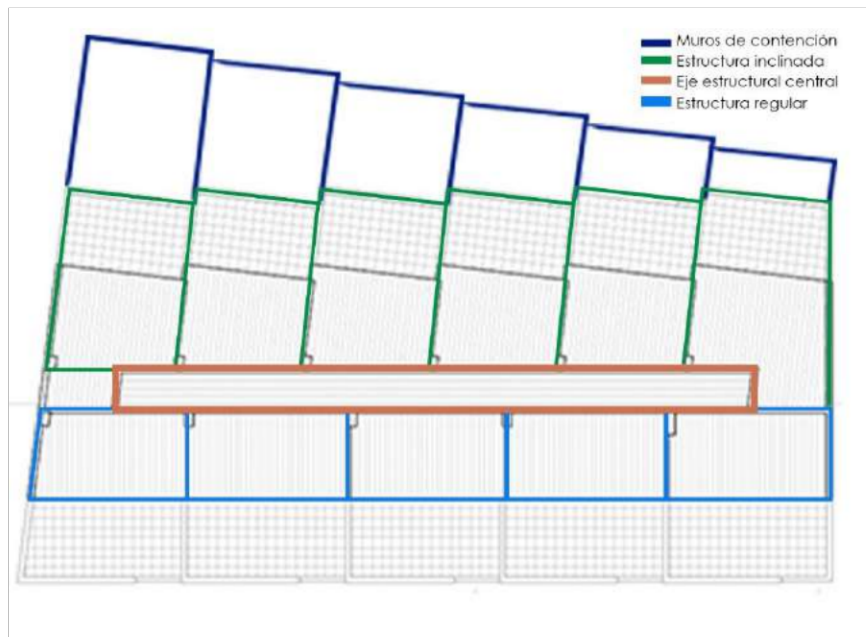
Disposición estructural del conjunto. // Fuente: (Mendizábal, 2009).
